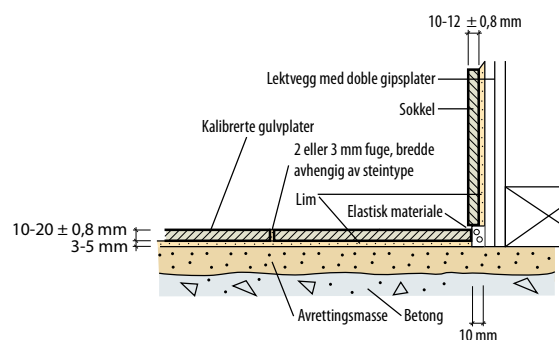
Liming på utjevnet betongunderlag. Typekonstruksjon G3.
